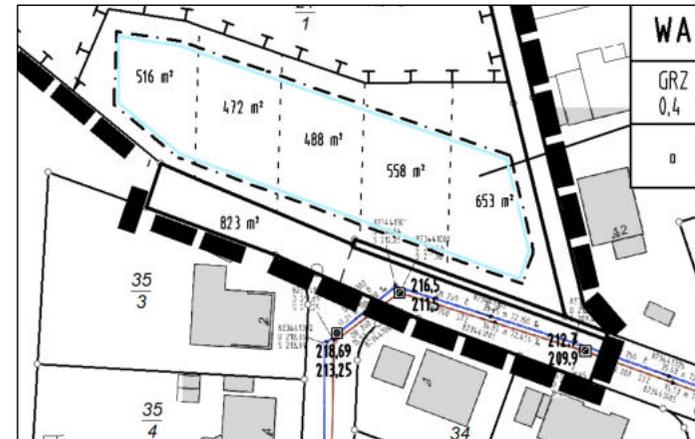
Lage der Abwasserleitungen mit Deckel- und Sohlhöhen
